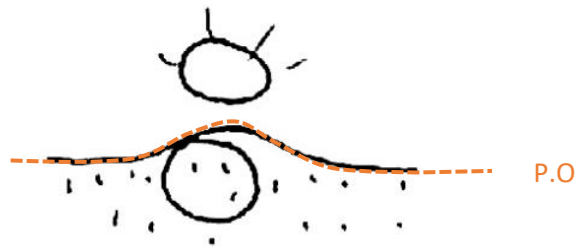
Sección trasversal de vivienda por debajo del plano horizontal del suelo. Boceto de elaboración propia.
